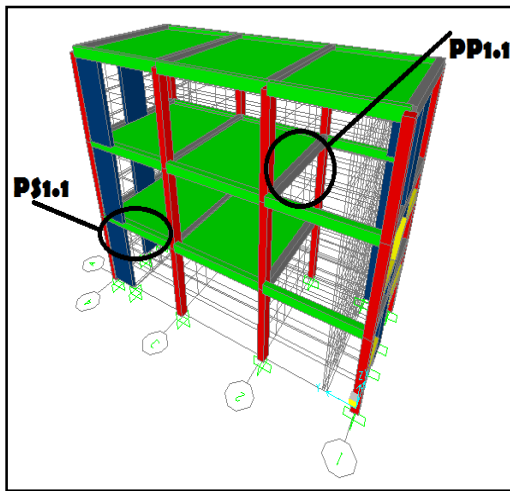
l'emplacement des poutres PP1.1 ; PS1.1
